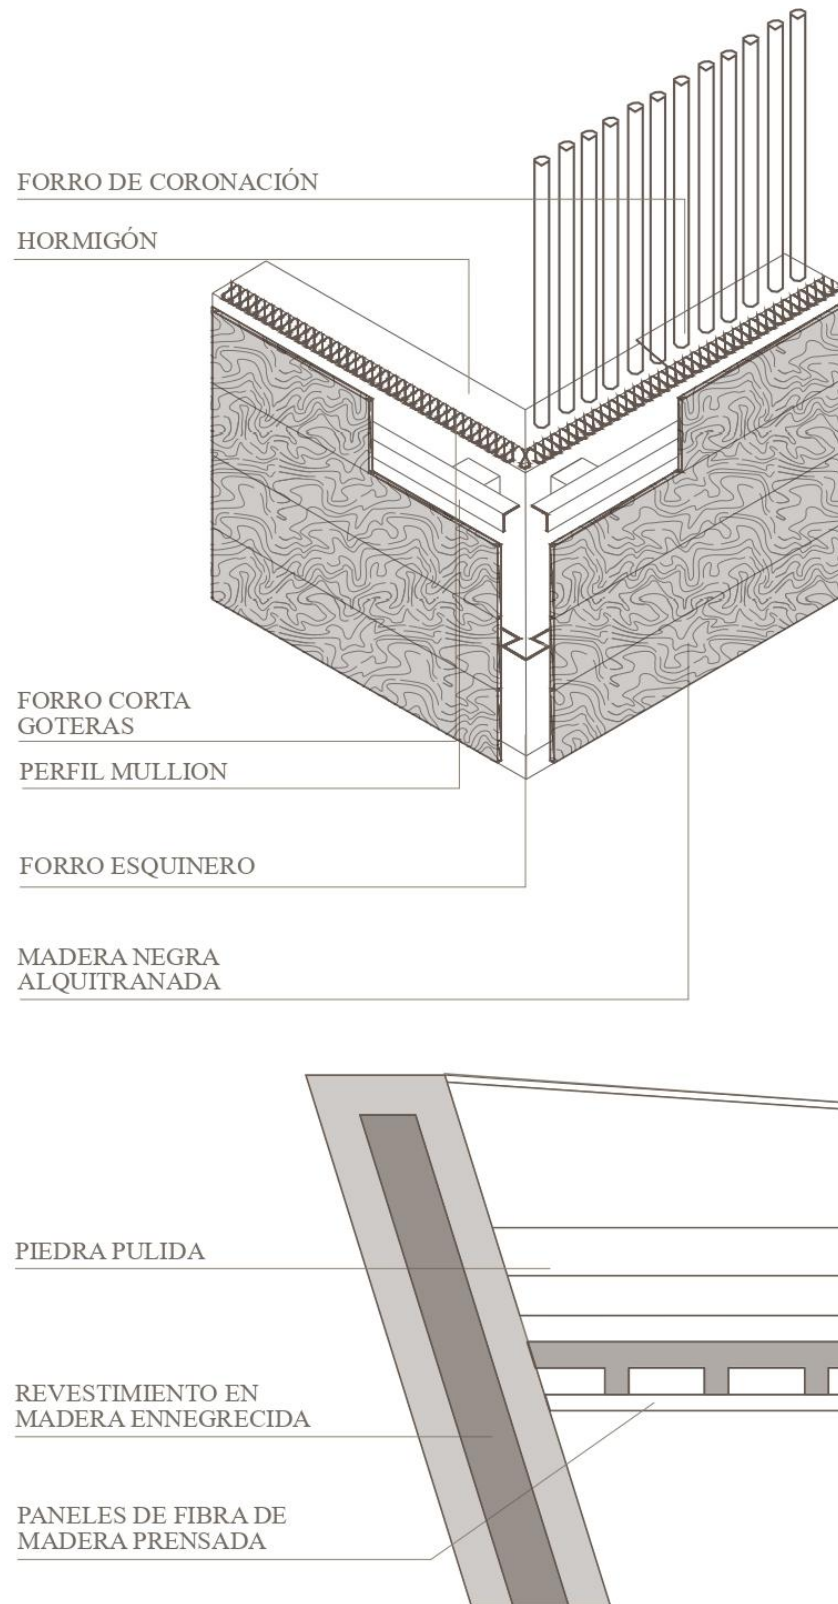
Detalles Constructivos Knut Hamsum Center (Autoría Propia 2025)
